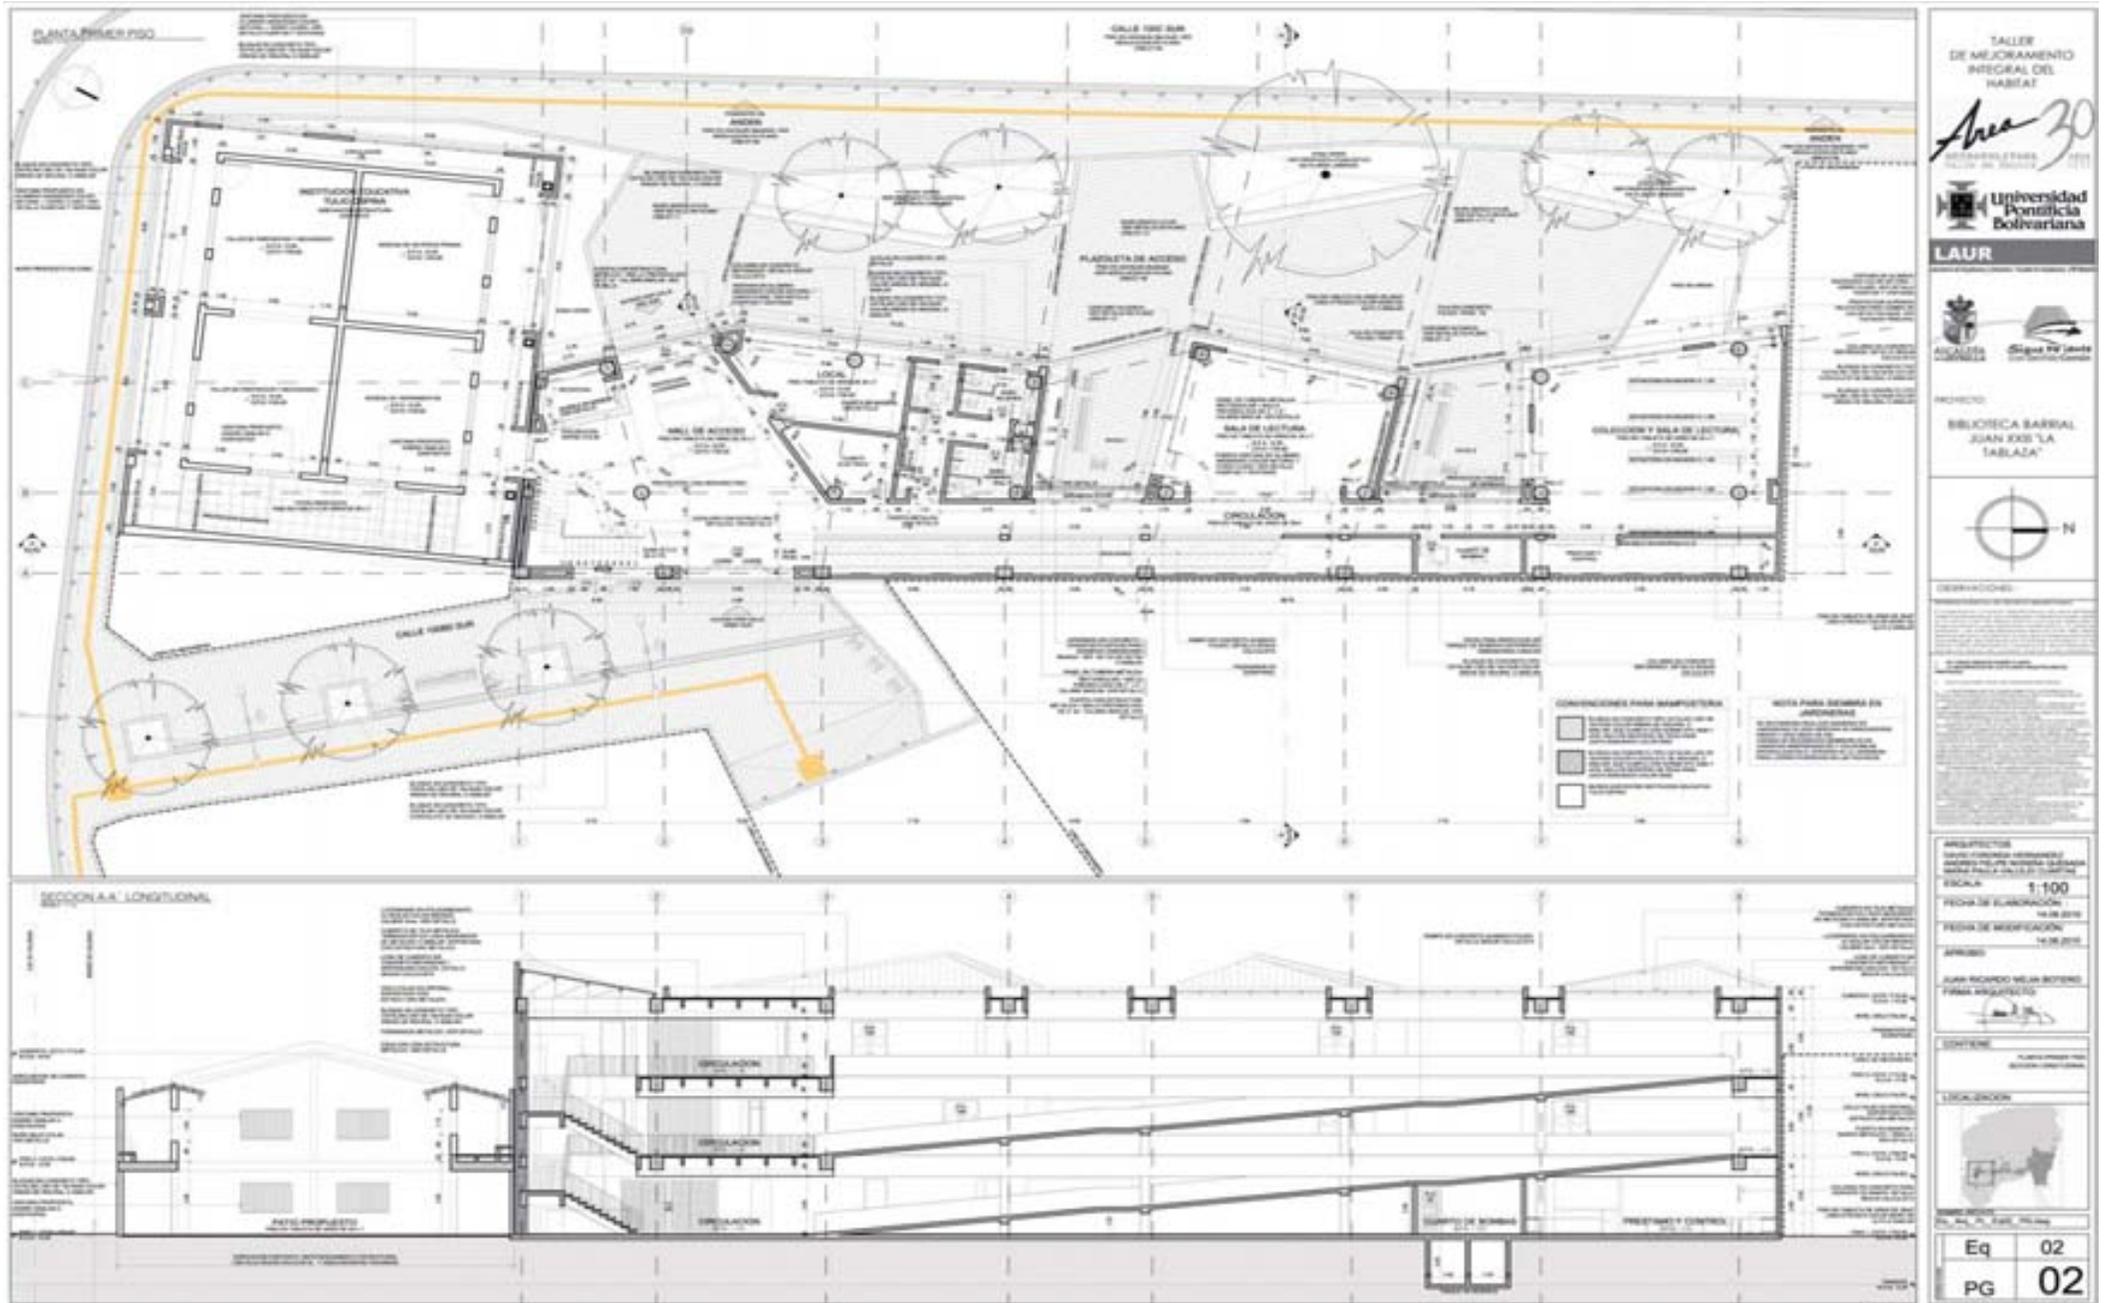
Planta nivel 1 y sección longitudinal. Proyecto Biblioteca barrial y centro de capacitación Tulio Ospina (Juan XXIII).
